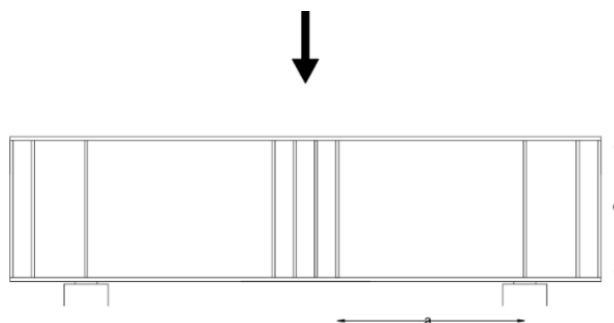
Configuração típica das vigas do Ensaio 2
